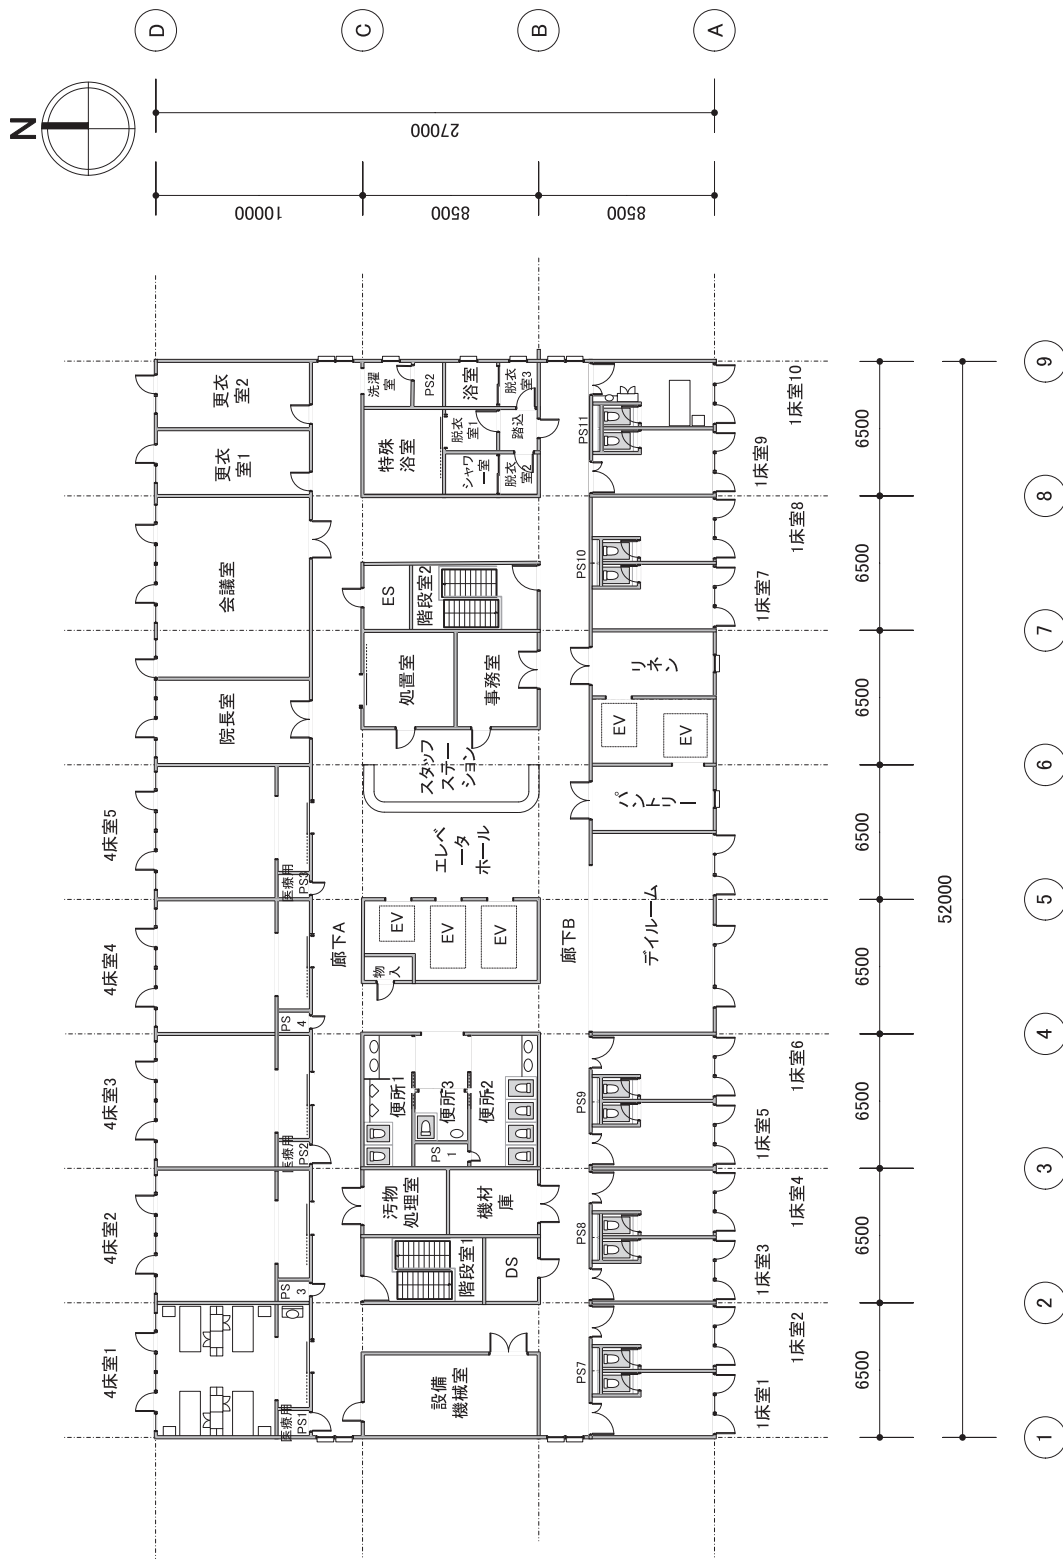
モデル建物 (病院等、5,000㎡) 3階平面図
